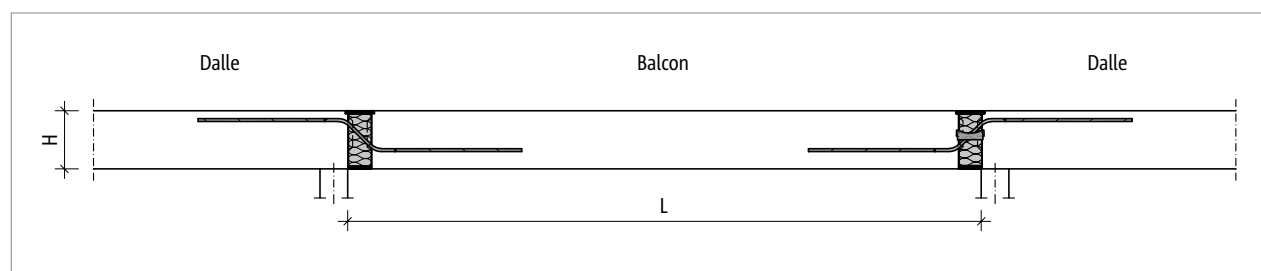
Schöck Isokorb® T Type Q-E-V, Q-E-Z-V : Système statique
